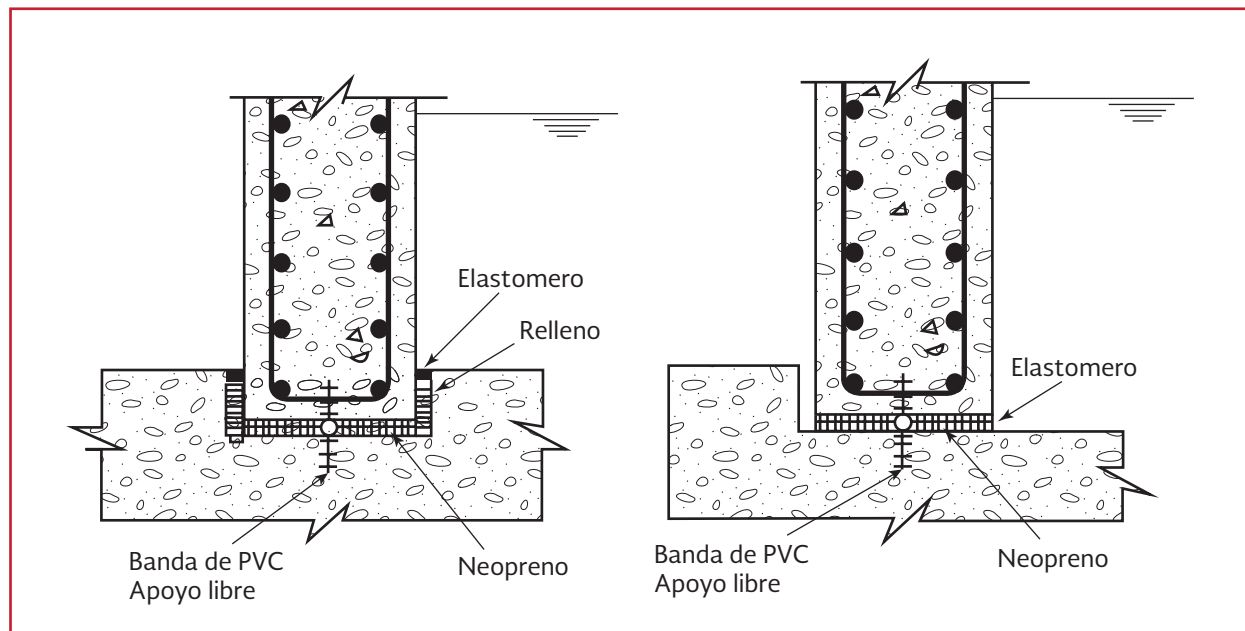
Junta estructural entre el muro y la cimentación
